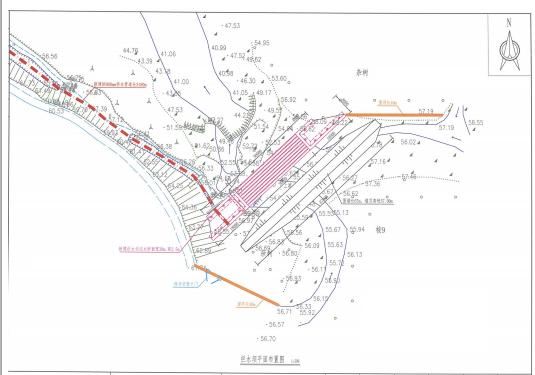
新建围网、镀锌钢管大门平面布置示意图
